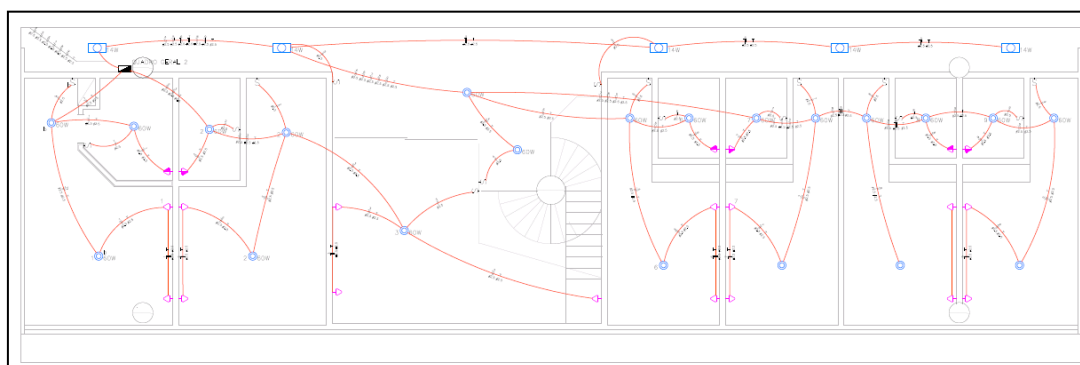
Distribuição da fiação no 1º pavimento. Fonte: AUTOR (2017).
